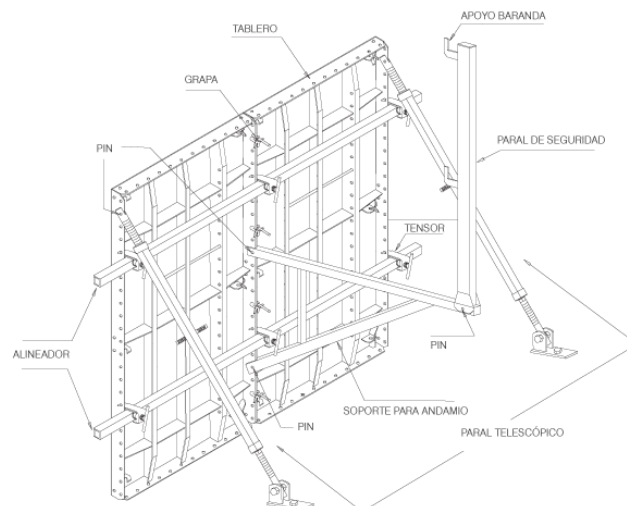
Modulación de un elemento tipo muro con formaleta metálica
